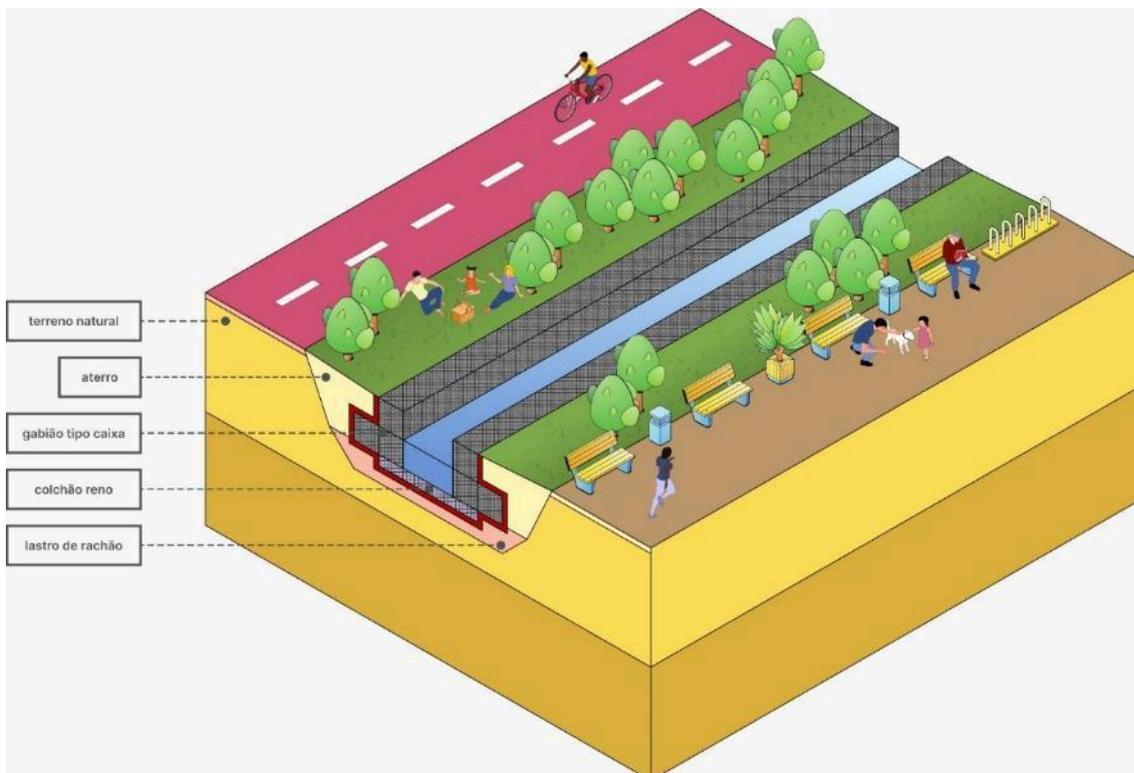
Esquemático de canalização com gabião (Fonte: PMRR)
